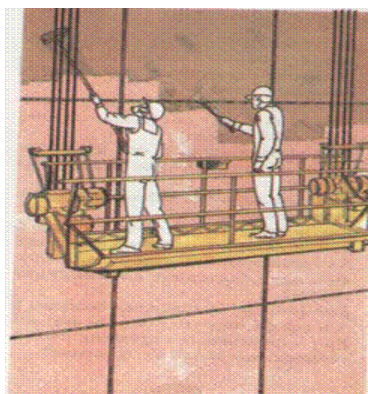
Окраска фасада с наружных трубчатых лесов.
